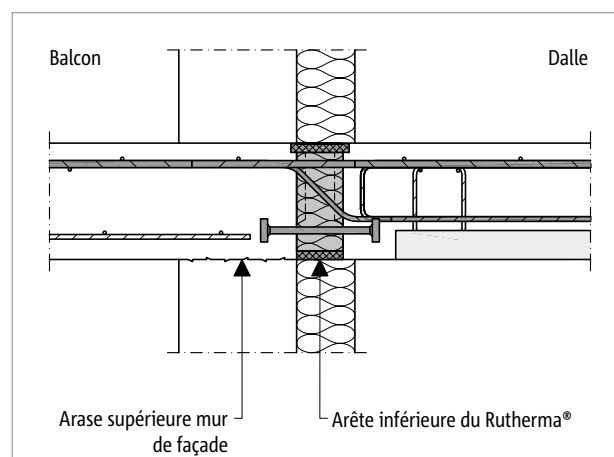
Schöck Rutherma® T type DB : balcon en béton coulé sur place avec plancher constitué de prédalles sur mur en béton armé
